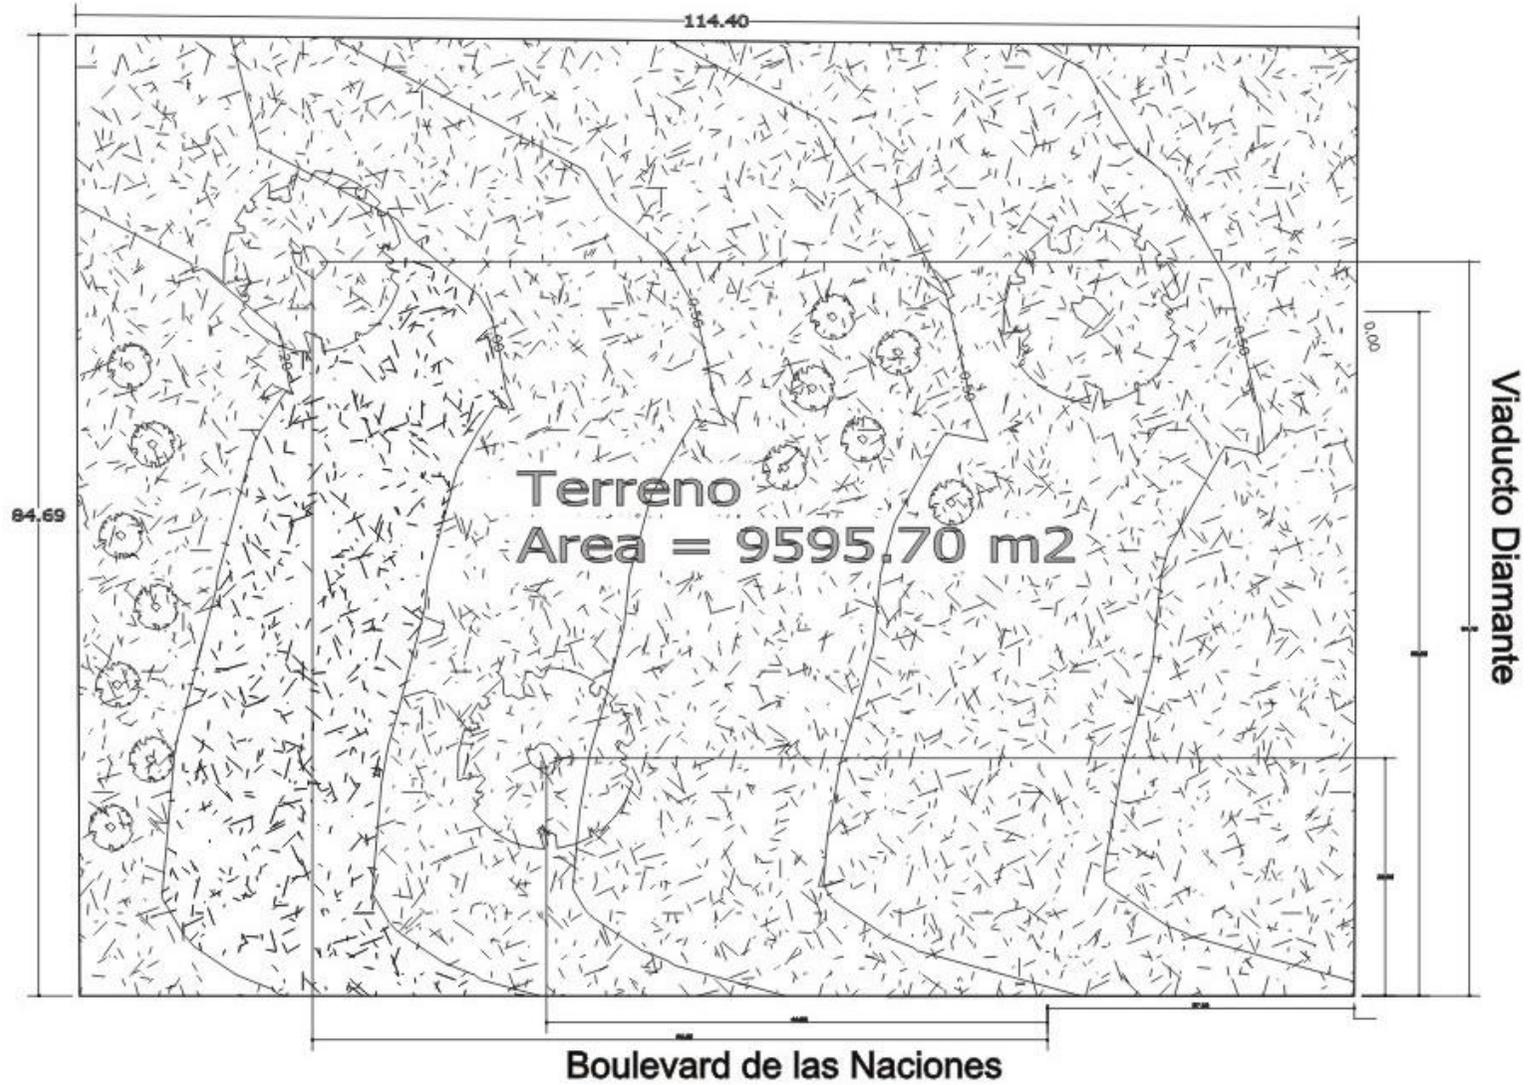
PLANTA GENERAL DEL TERRENO.
